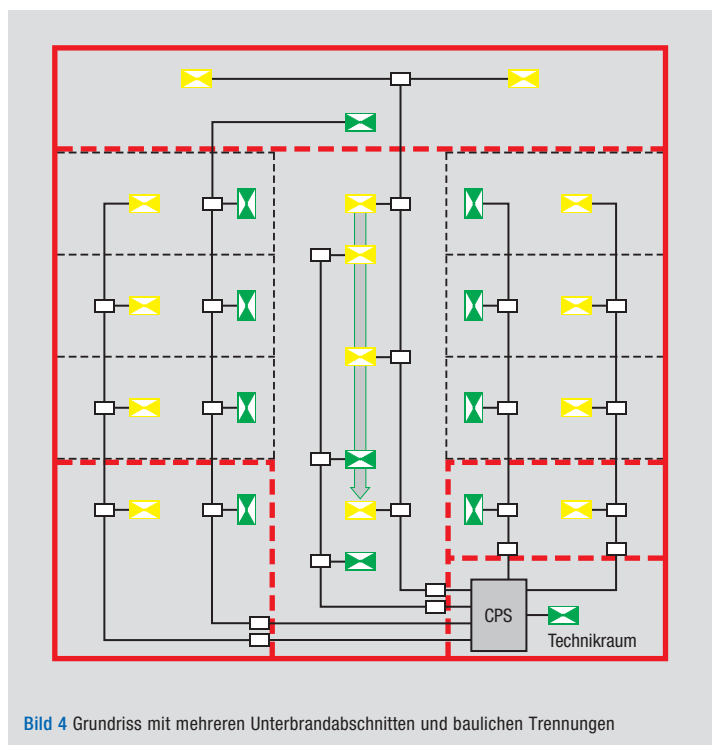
Grundriss mit mehreren Unterbrandabschnitten und baulichen Trennungen
